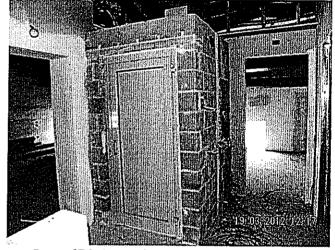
Secondo piano: Ballatoio scale-Ascensore
